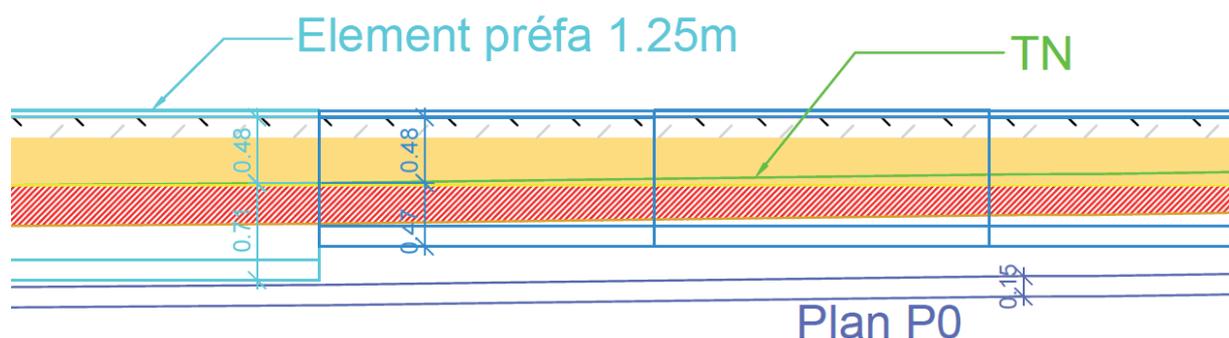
Principe d'implantation des éléments du mur de soutènement (Zoom)
